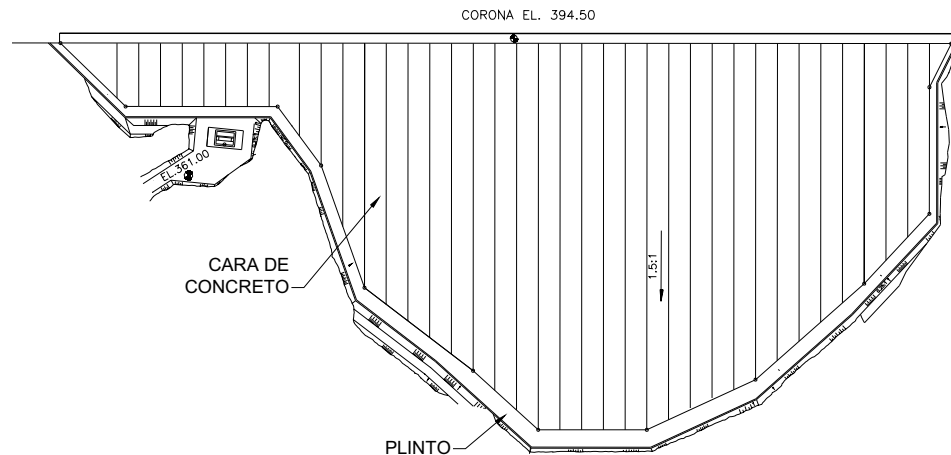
Vista frontal del plinto y de la cara de concreto de la cortina de un proyecto similar.
